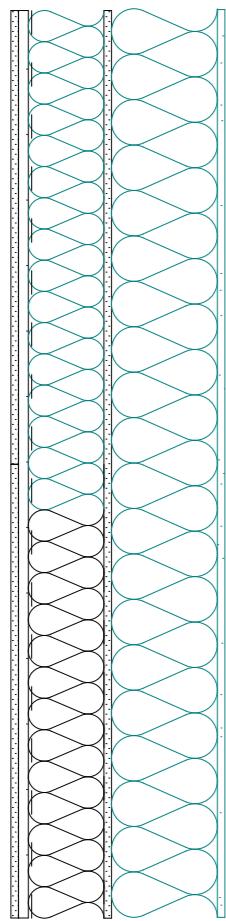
{A2} - ZUNANJA STENA M = 1:10
